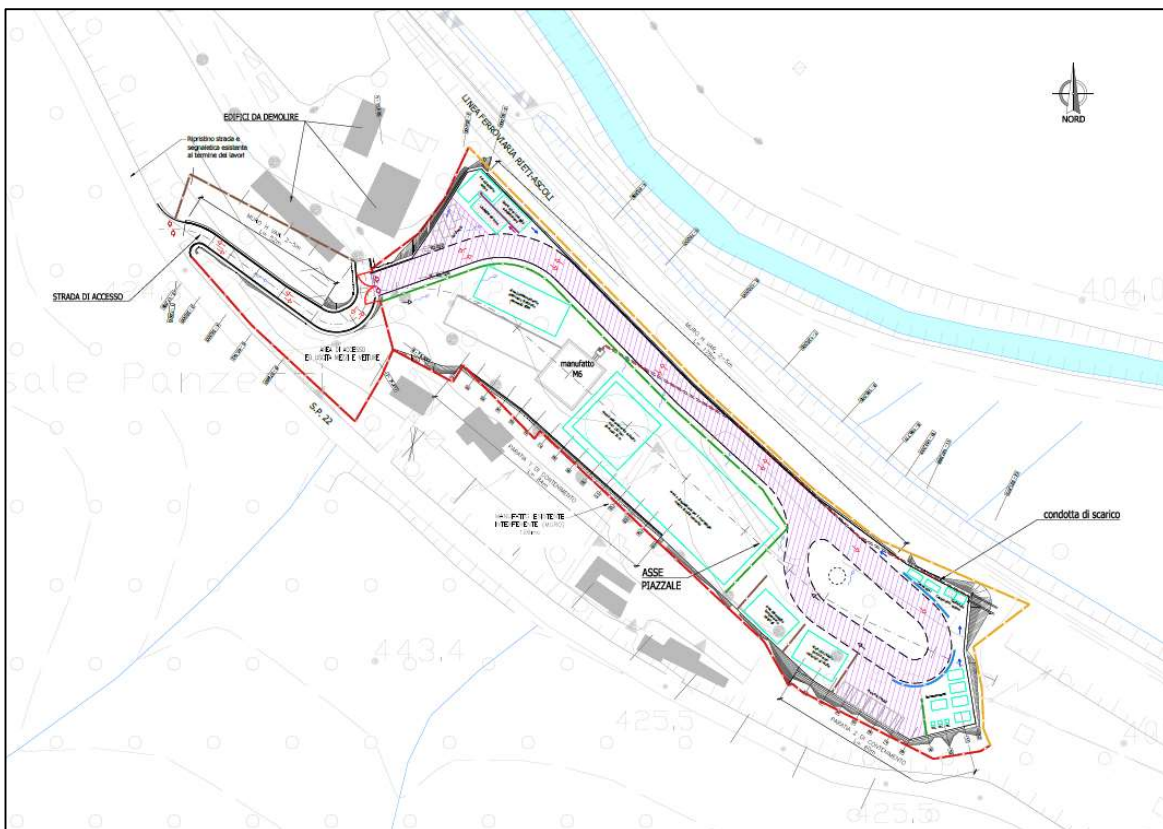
Area di cantiere M6 e Viabilità di accesso
